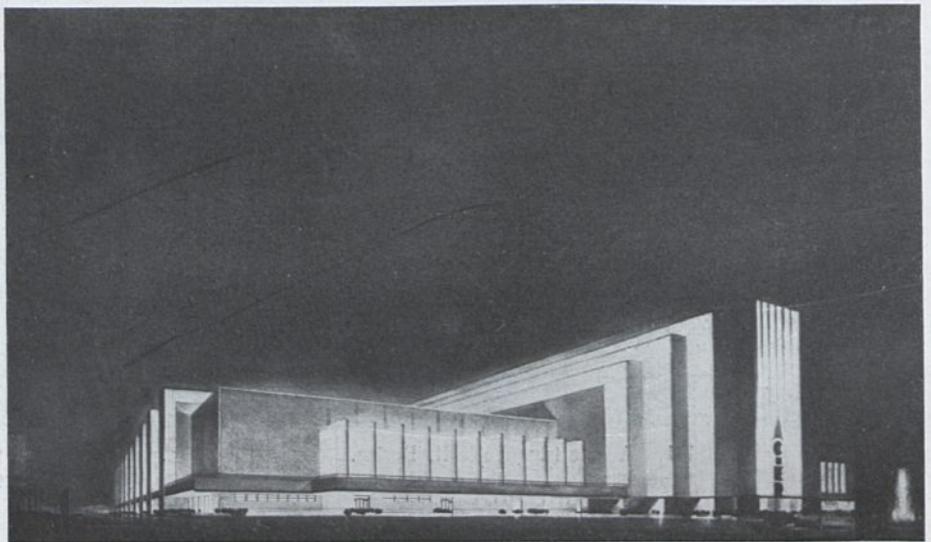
Entwurf A. und P. Fournier für die Pariser Ausstellungshalle.
